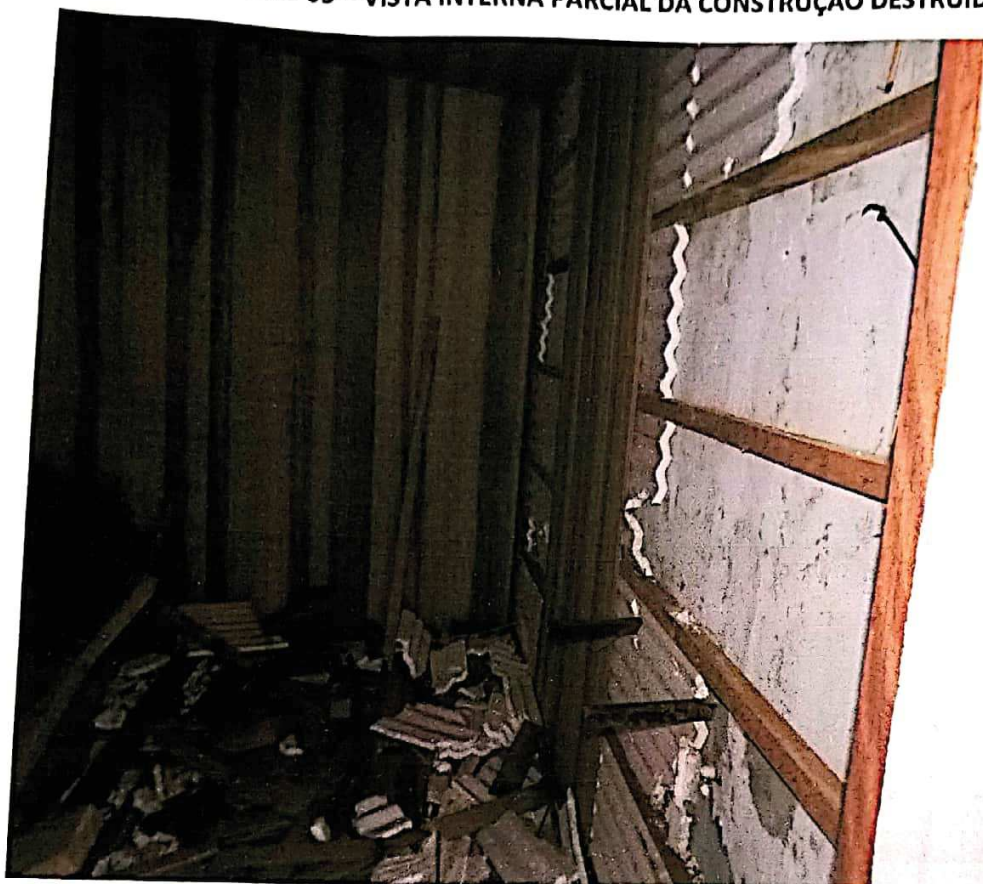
VISTA INTERNA DA CONSTRUÇÃO DESTRUÍDA
